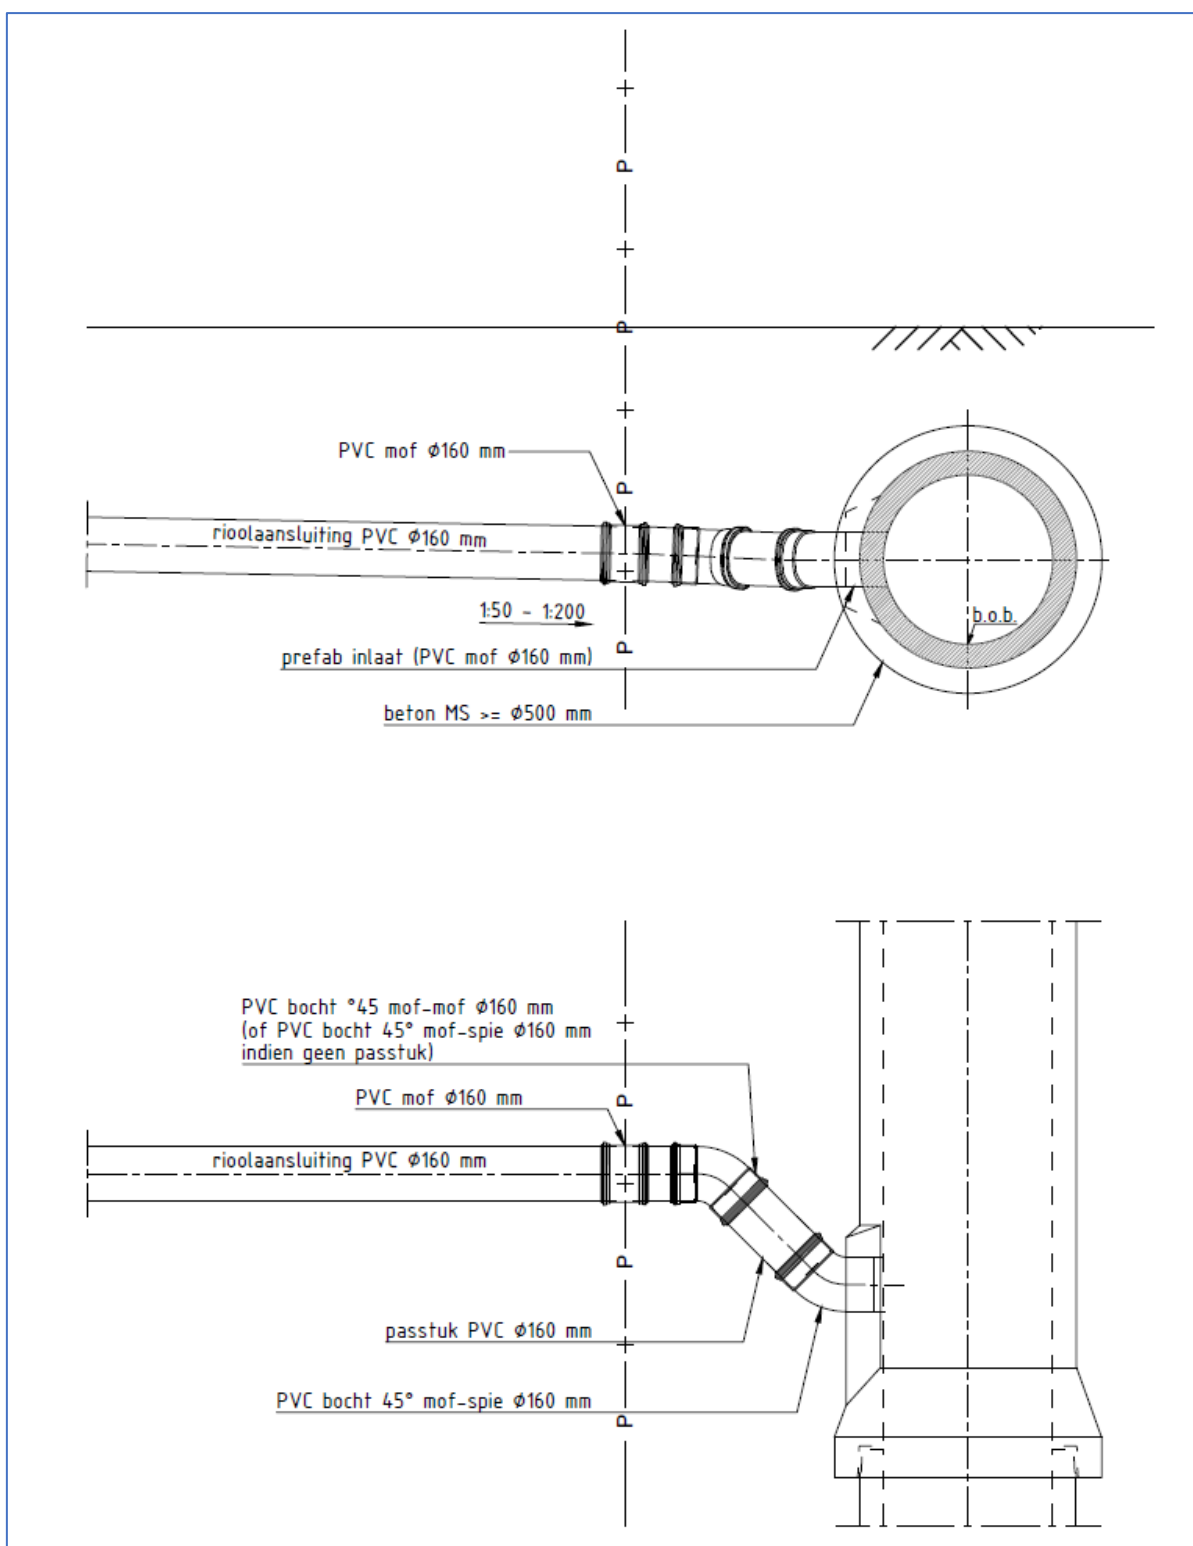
Detail riool zijaansluiting 45 graden op betonnen riool, erfgrans op tuin.
